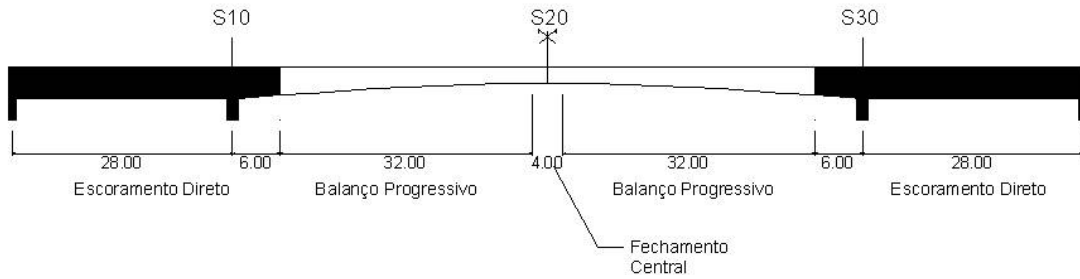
Perfil longitudinal da estrutura após o fechamento do vão
